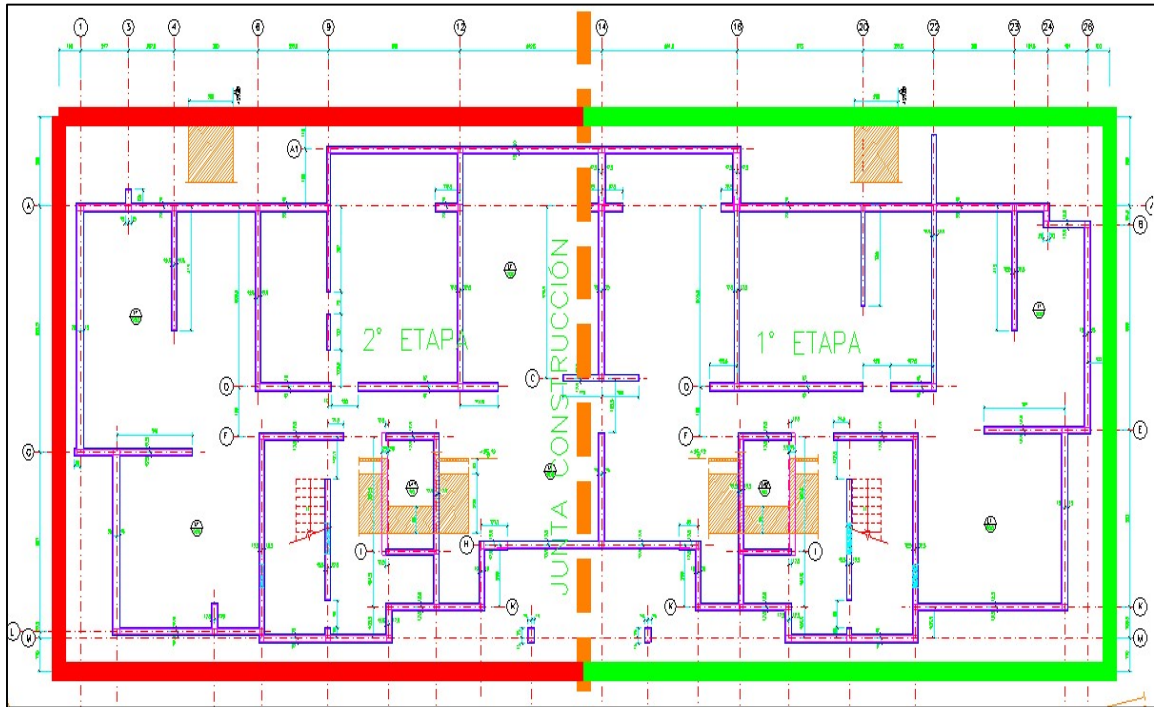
JUNTA DE CONSTRUCCIÓN
